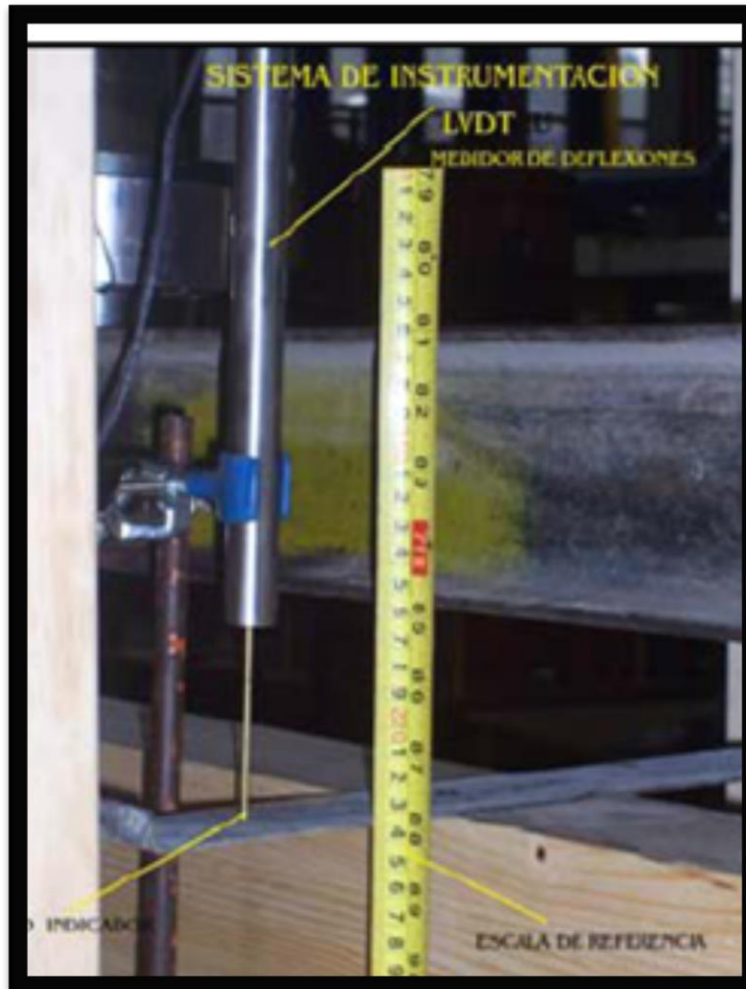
Dispositivo LVDT con el que fueron instrumentadas las vigas de madera.
